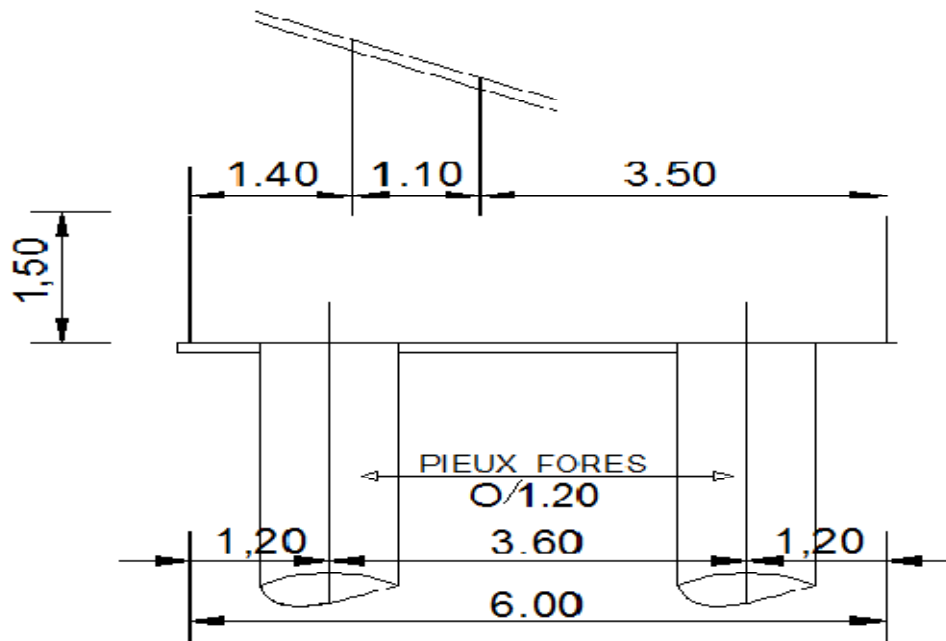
Pré dimensionnement de la semelle de liaison
